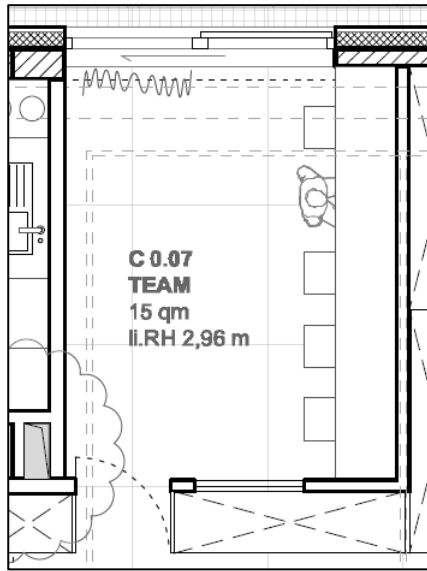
Grundriss Team, unmaßstäblich /12/
